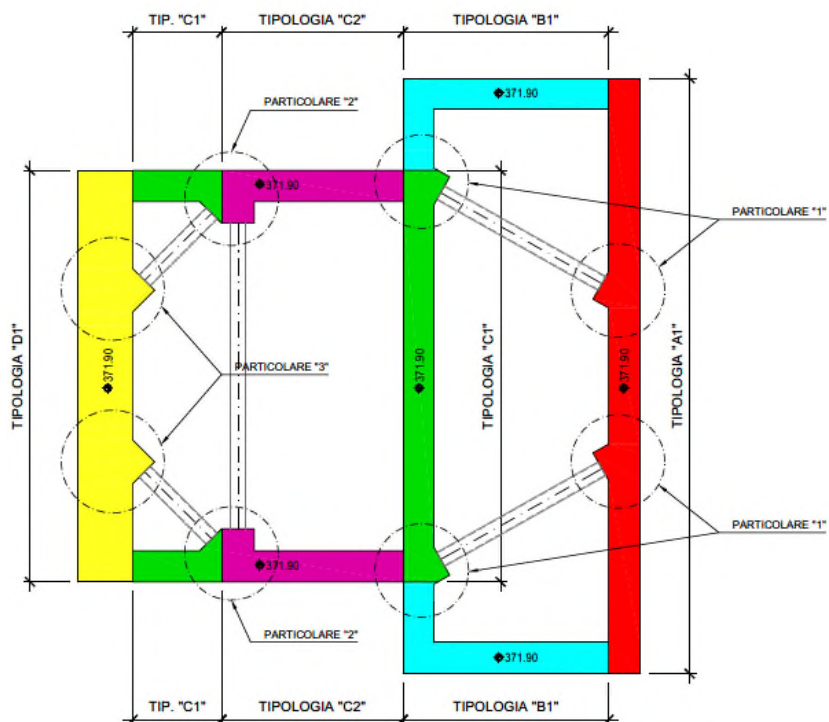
Pianta Trave di coronamento a q.ta +371.9m
